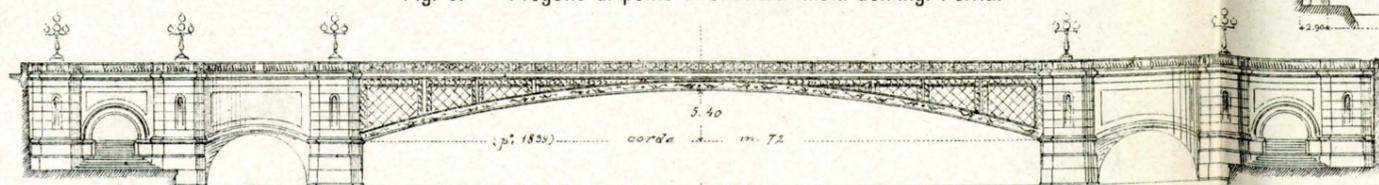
Progetto di ponte di struttura mista dell'Ing. Ferria.
